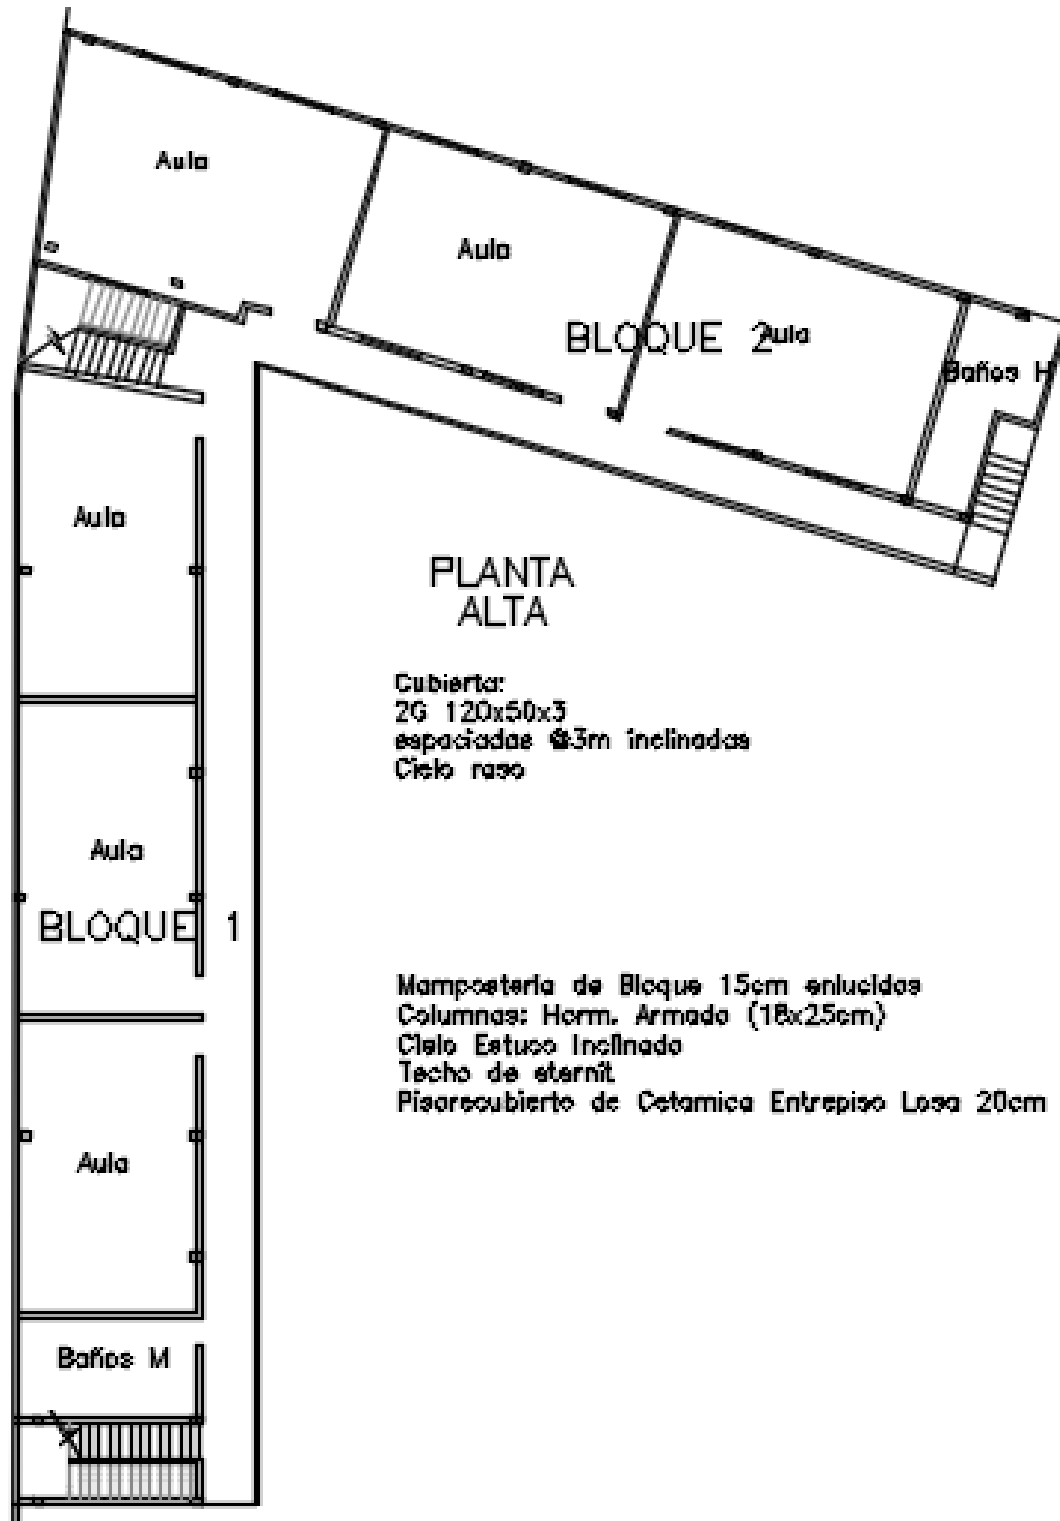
Levantamiento planimétrico de la Planta Alta de la Unidad Educativa "Nuestra Familia"
